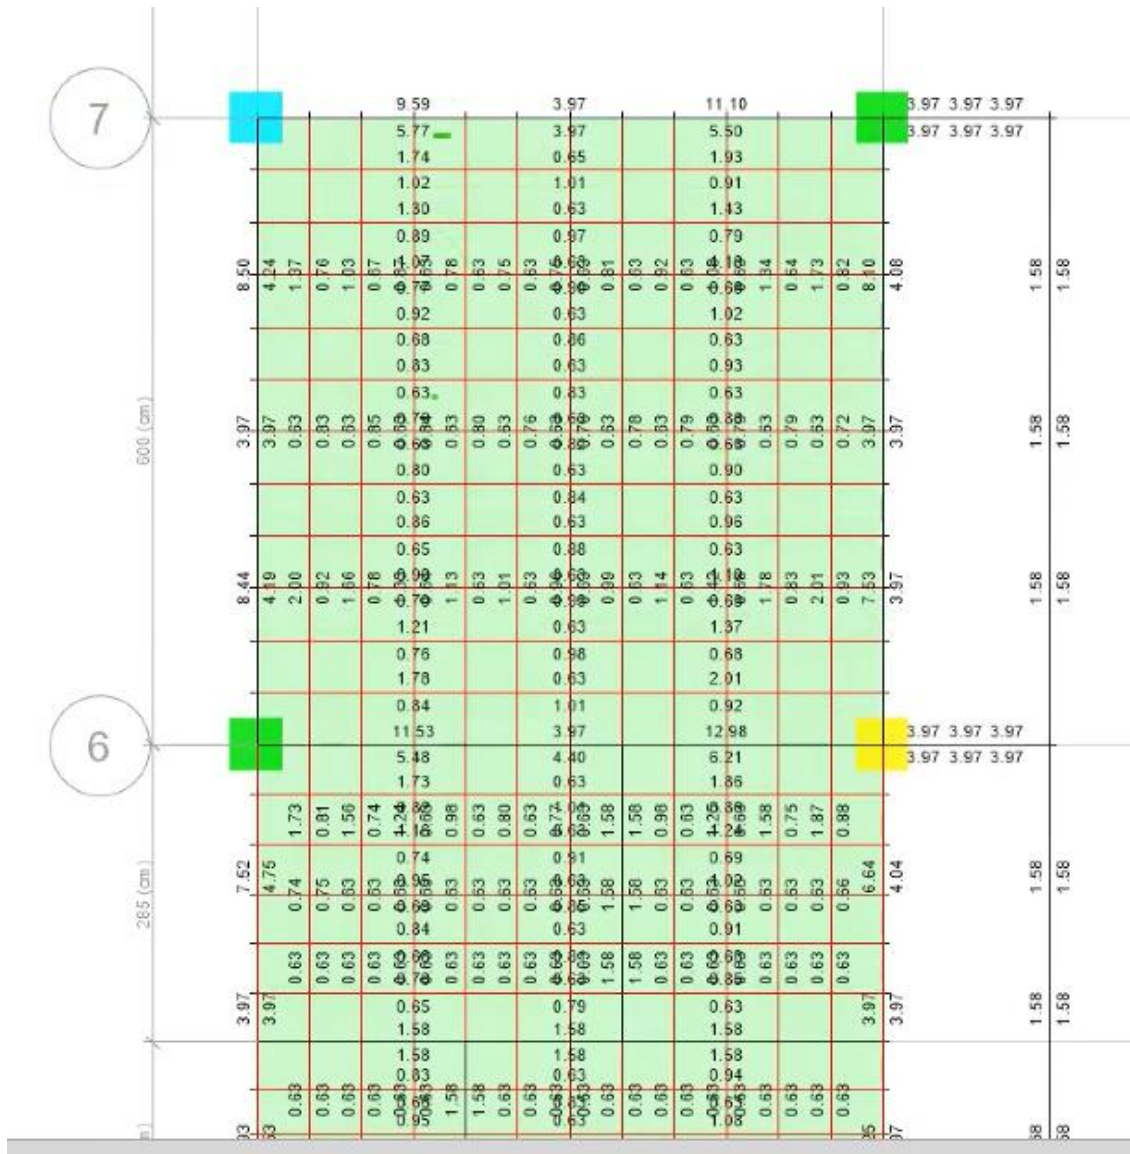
Distribución de Acero en Losa Aligerada – (ETABS)
